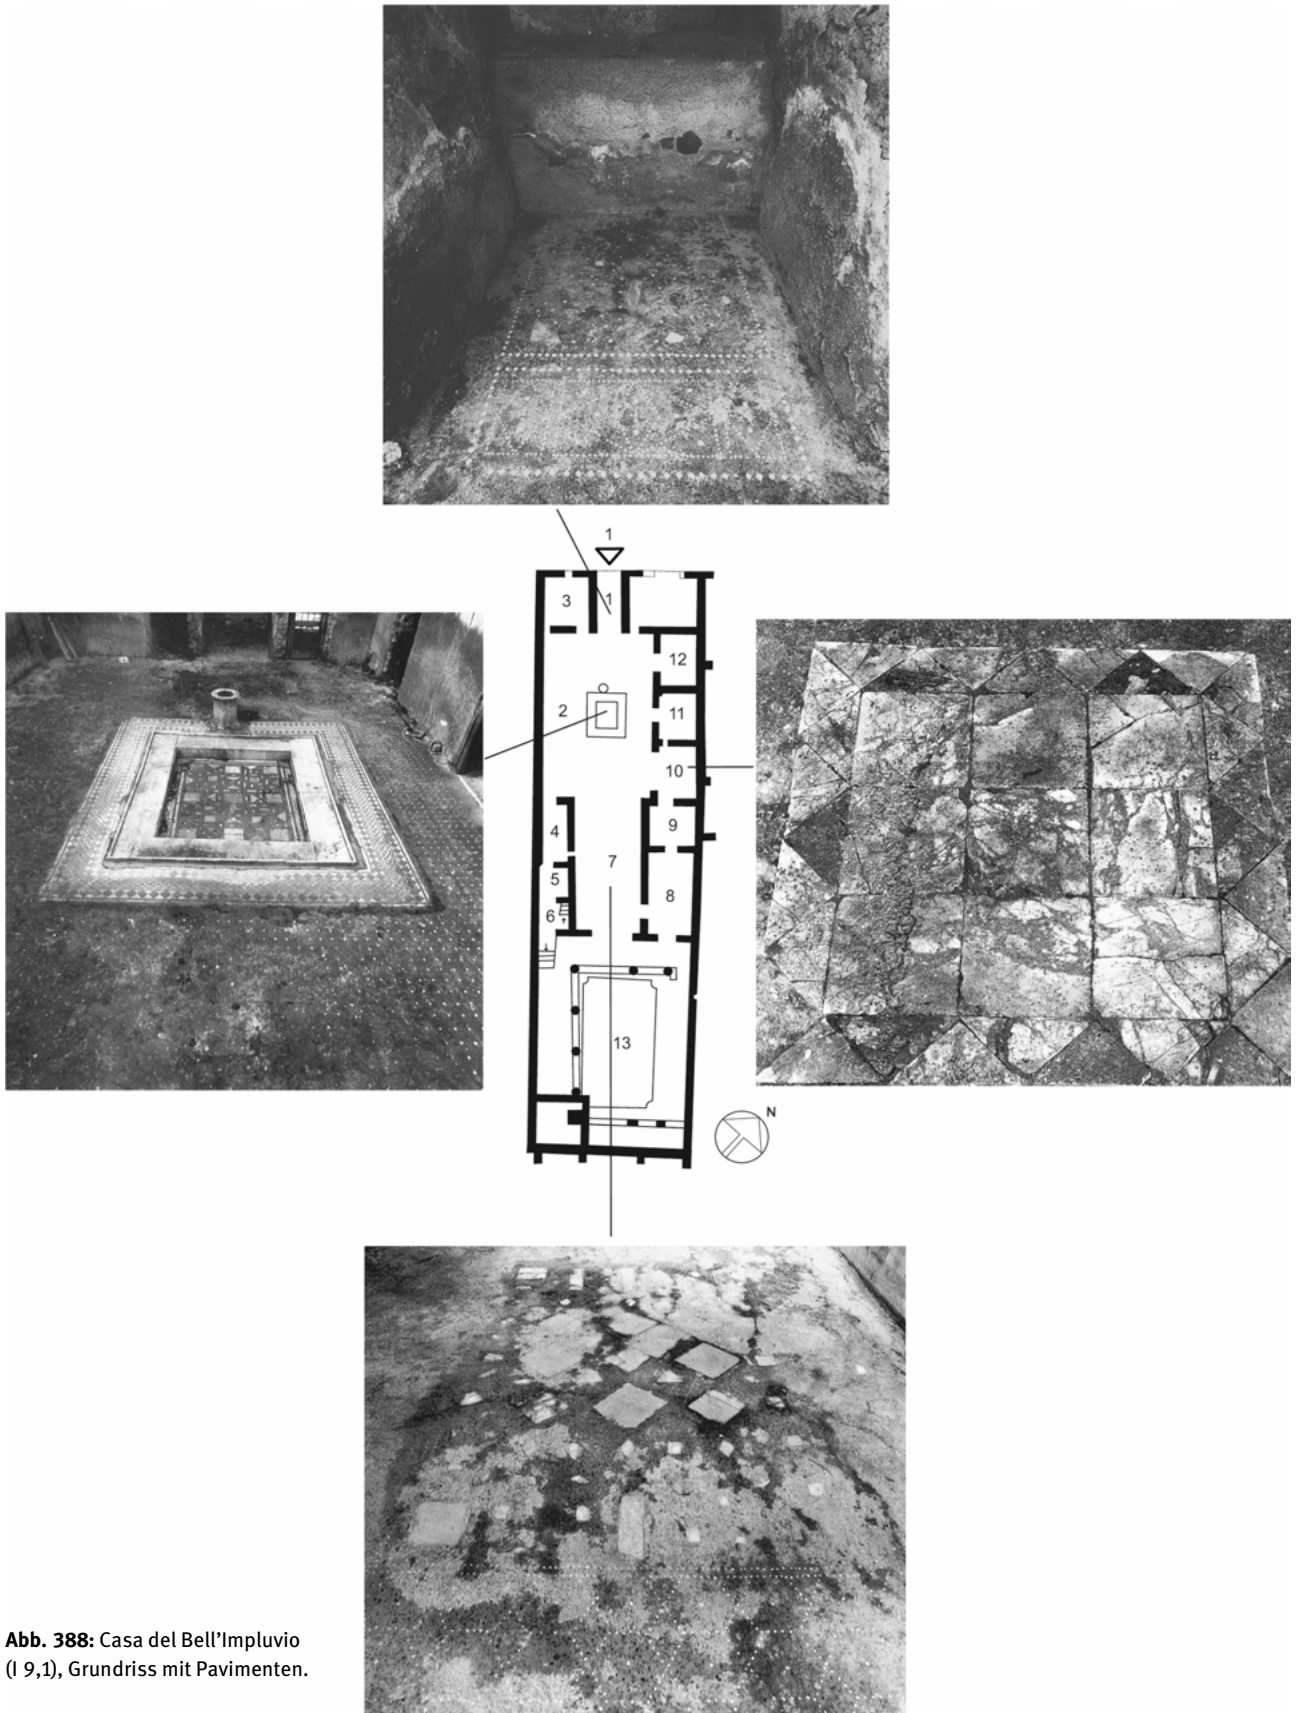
Casa del Bell'Impluvio (I 9,1), Grundriss mit Pavimenten.
